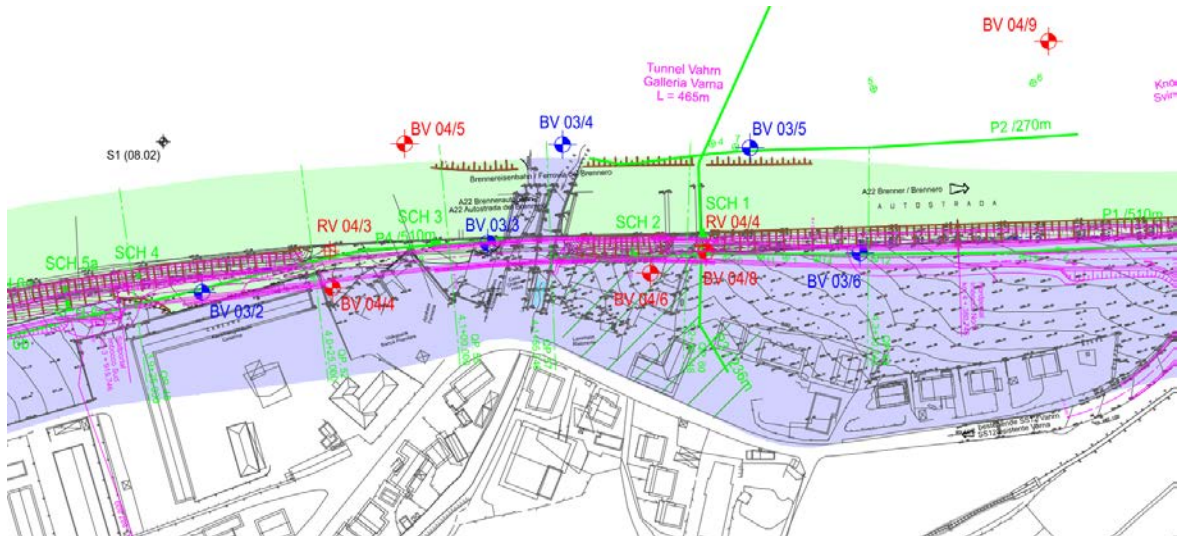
Estratto dalla planimetria con affioramenti del terreno da BV-U-603
